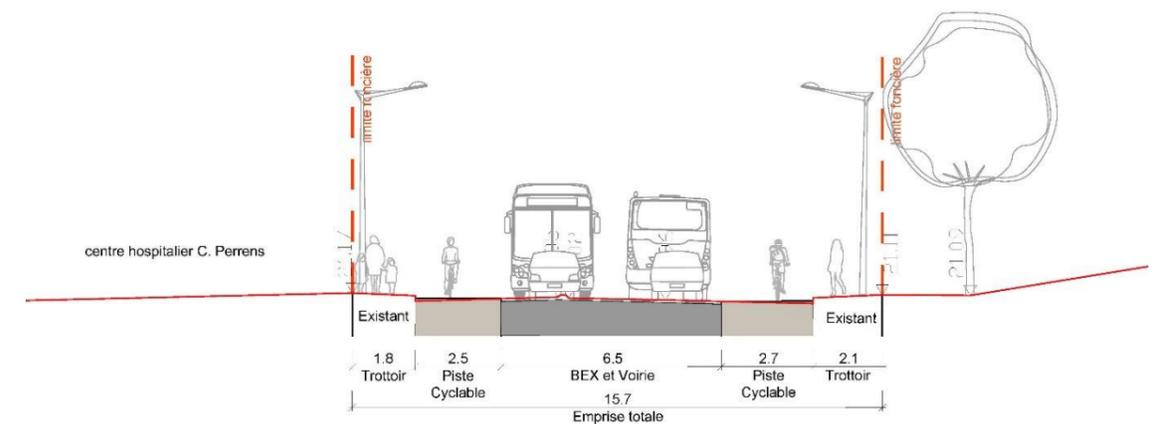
Coupe type sur la rue de la Béchade en section courante
